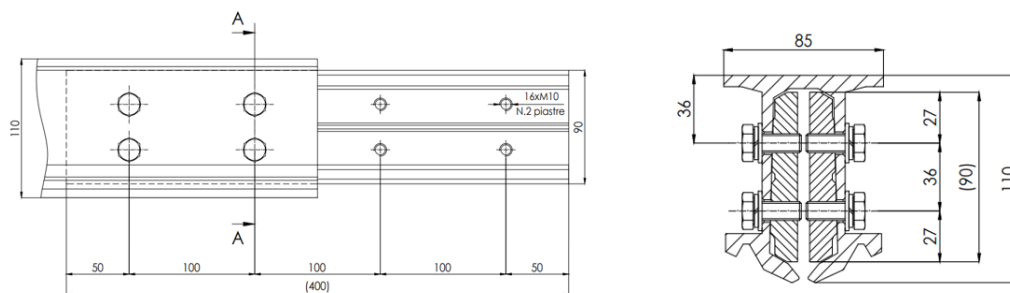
Vista longitudinale e sezione A-A delle piastre di giunzione
